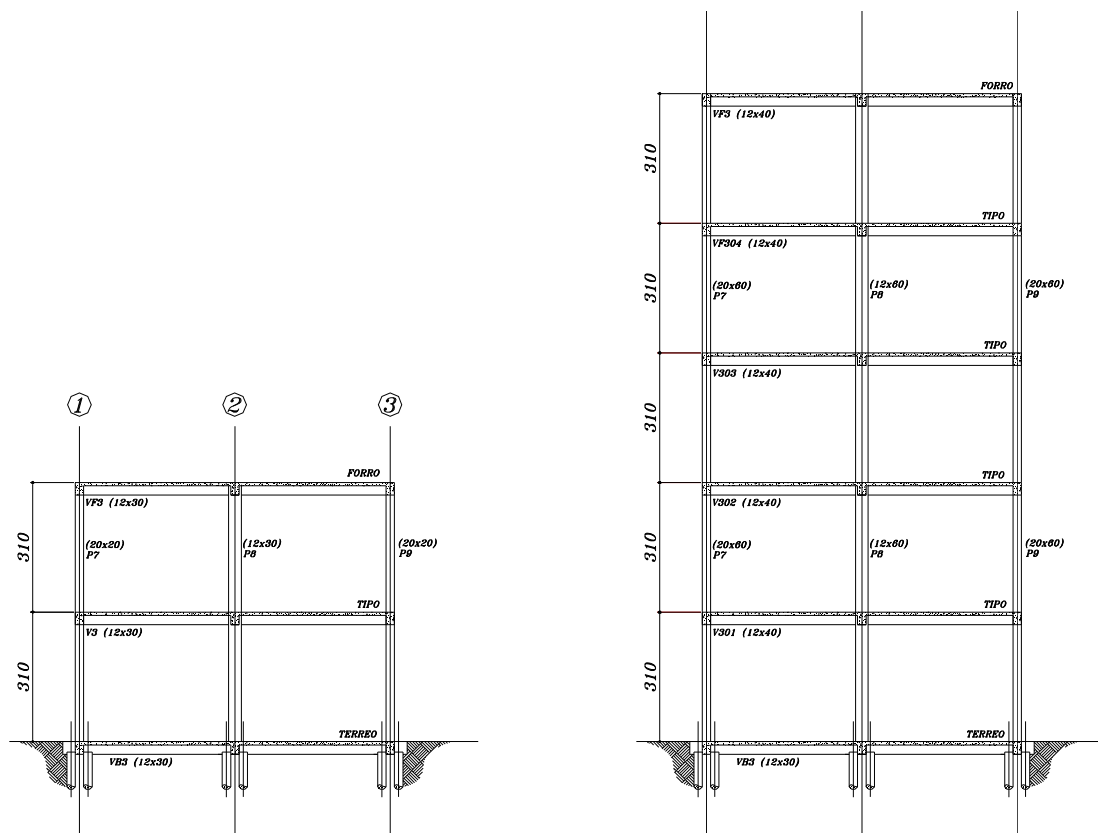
Corte Esquemático 2 e 5 pavimentos
